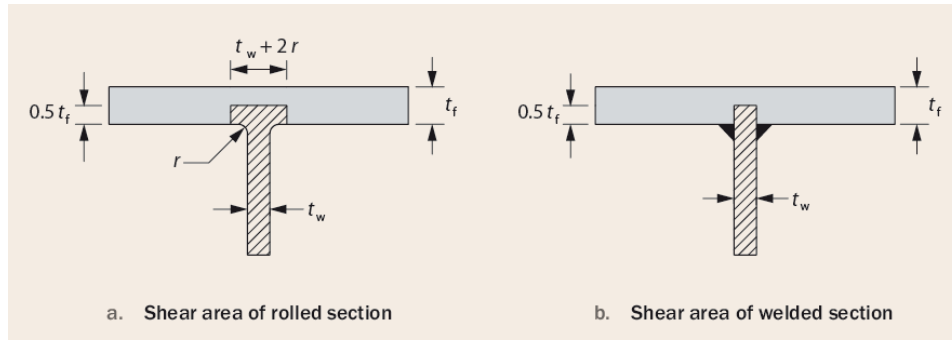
Área de resistência ao corte para: a. Secções laminadas e b. Secções soldadas, [6].
